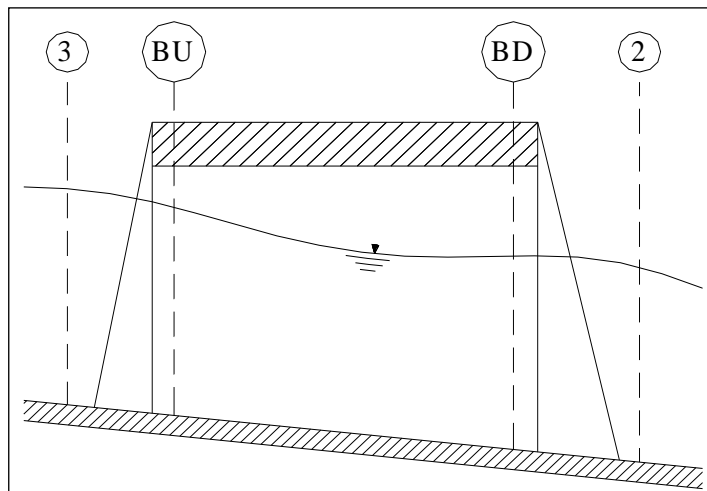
Sezione schematica di un attraversamento fluviale
